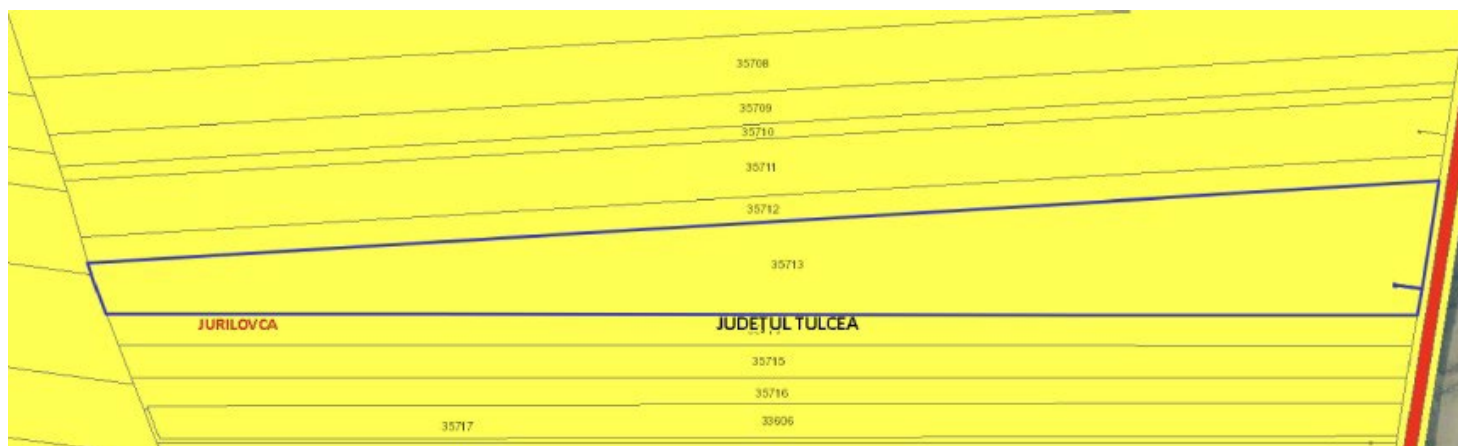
Plan de situatie si Plan de amplasament a obiectivului
